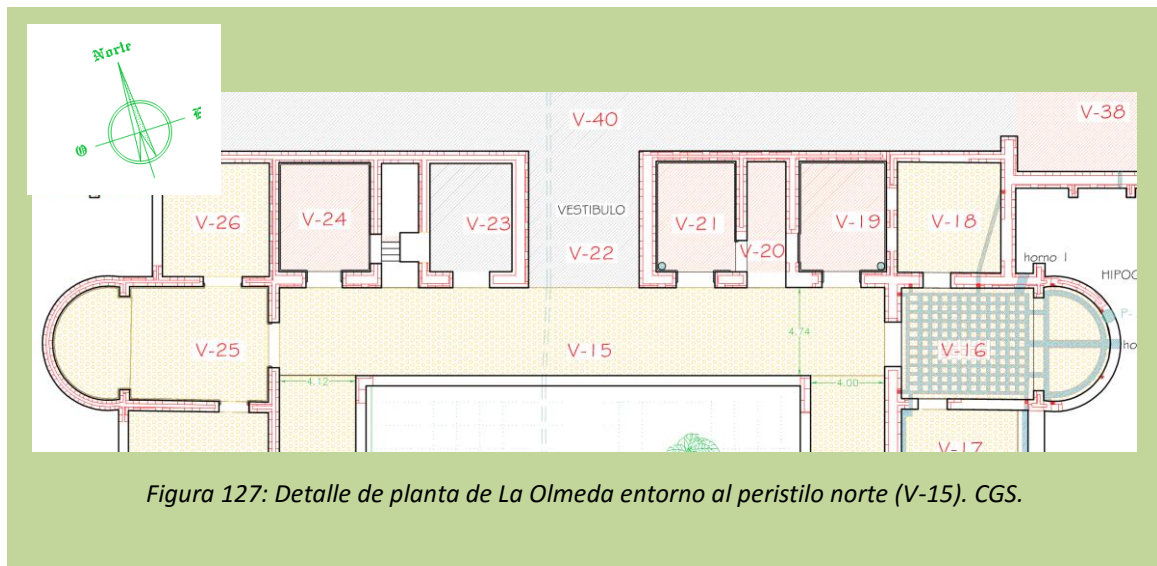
Detalle de planta de La Olmeda entorno al peristilo norte (V-15). CGS.
